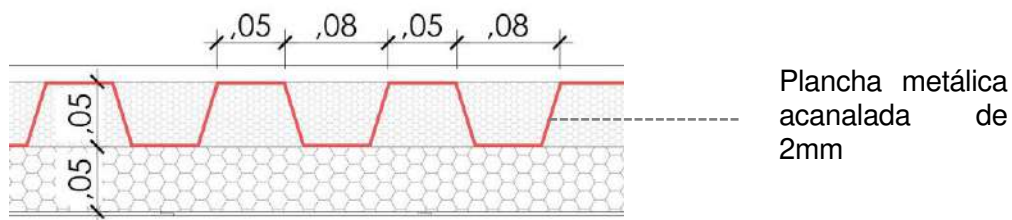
Se muestra las dimensiones de los dobleces de la plancha acanalada.
